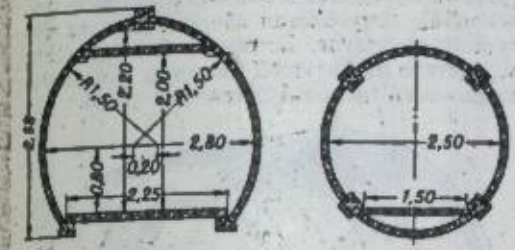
Сборные железобетонные обделки подземных сооружений.
